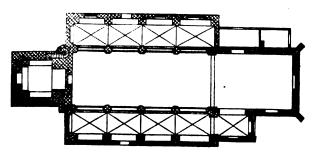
Gingst. Kirche. Grundriss. 1:667.
